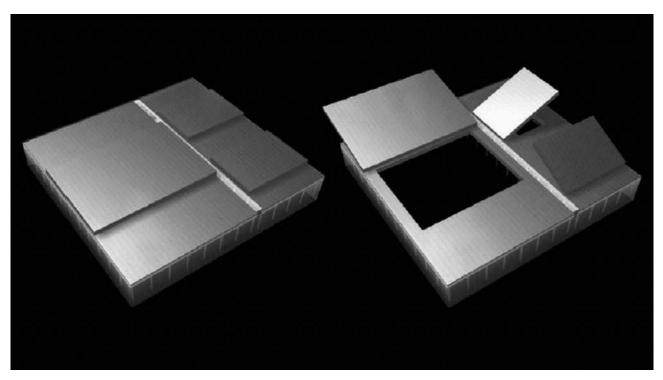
Solución de la apertura de los paneles móviles para los tres estadios. Cerrado y abierto.
